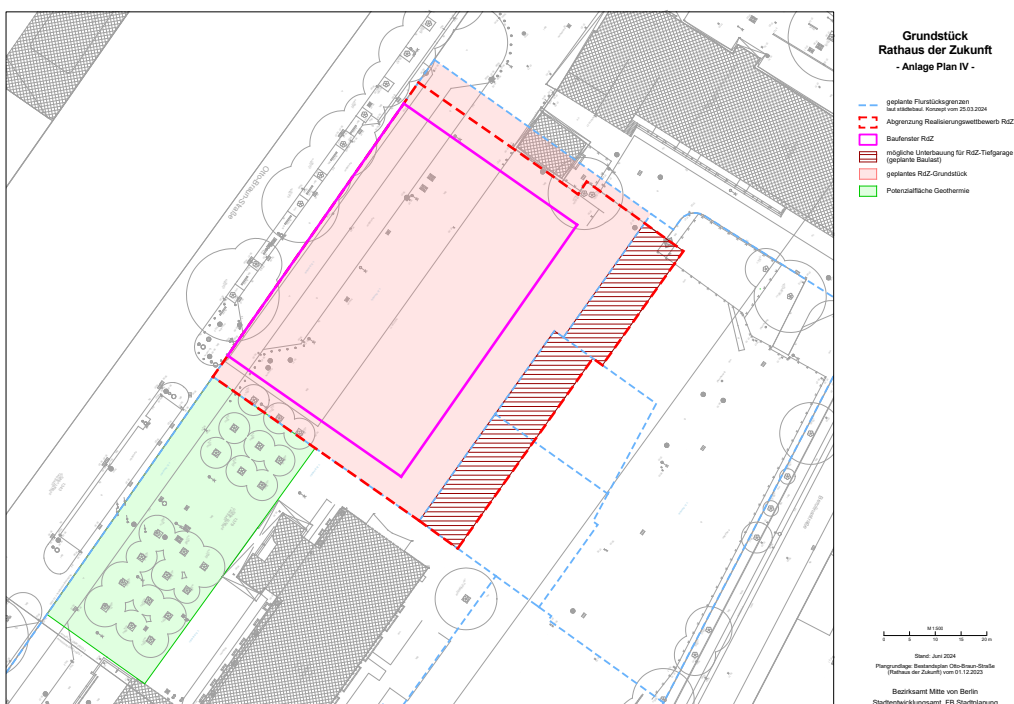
Vermesserplan mit Darstellung der geplanten Grundstückneubildung
